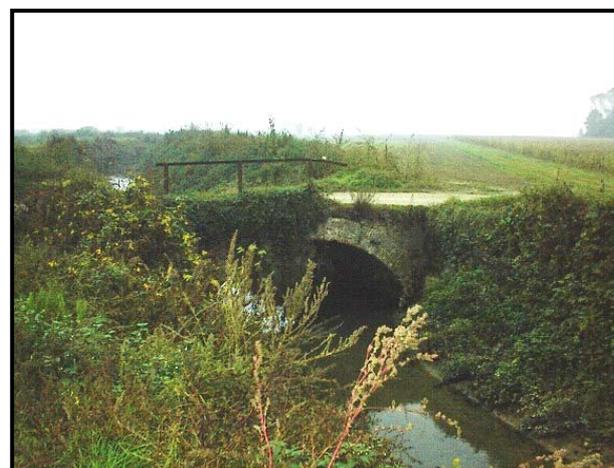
Vista da valle dell'attraversamento di una strada lungo il torrente Rotaldo, a monte del Lanza.
